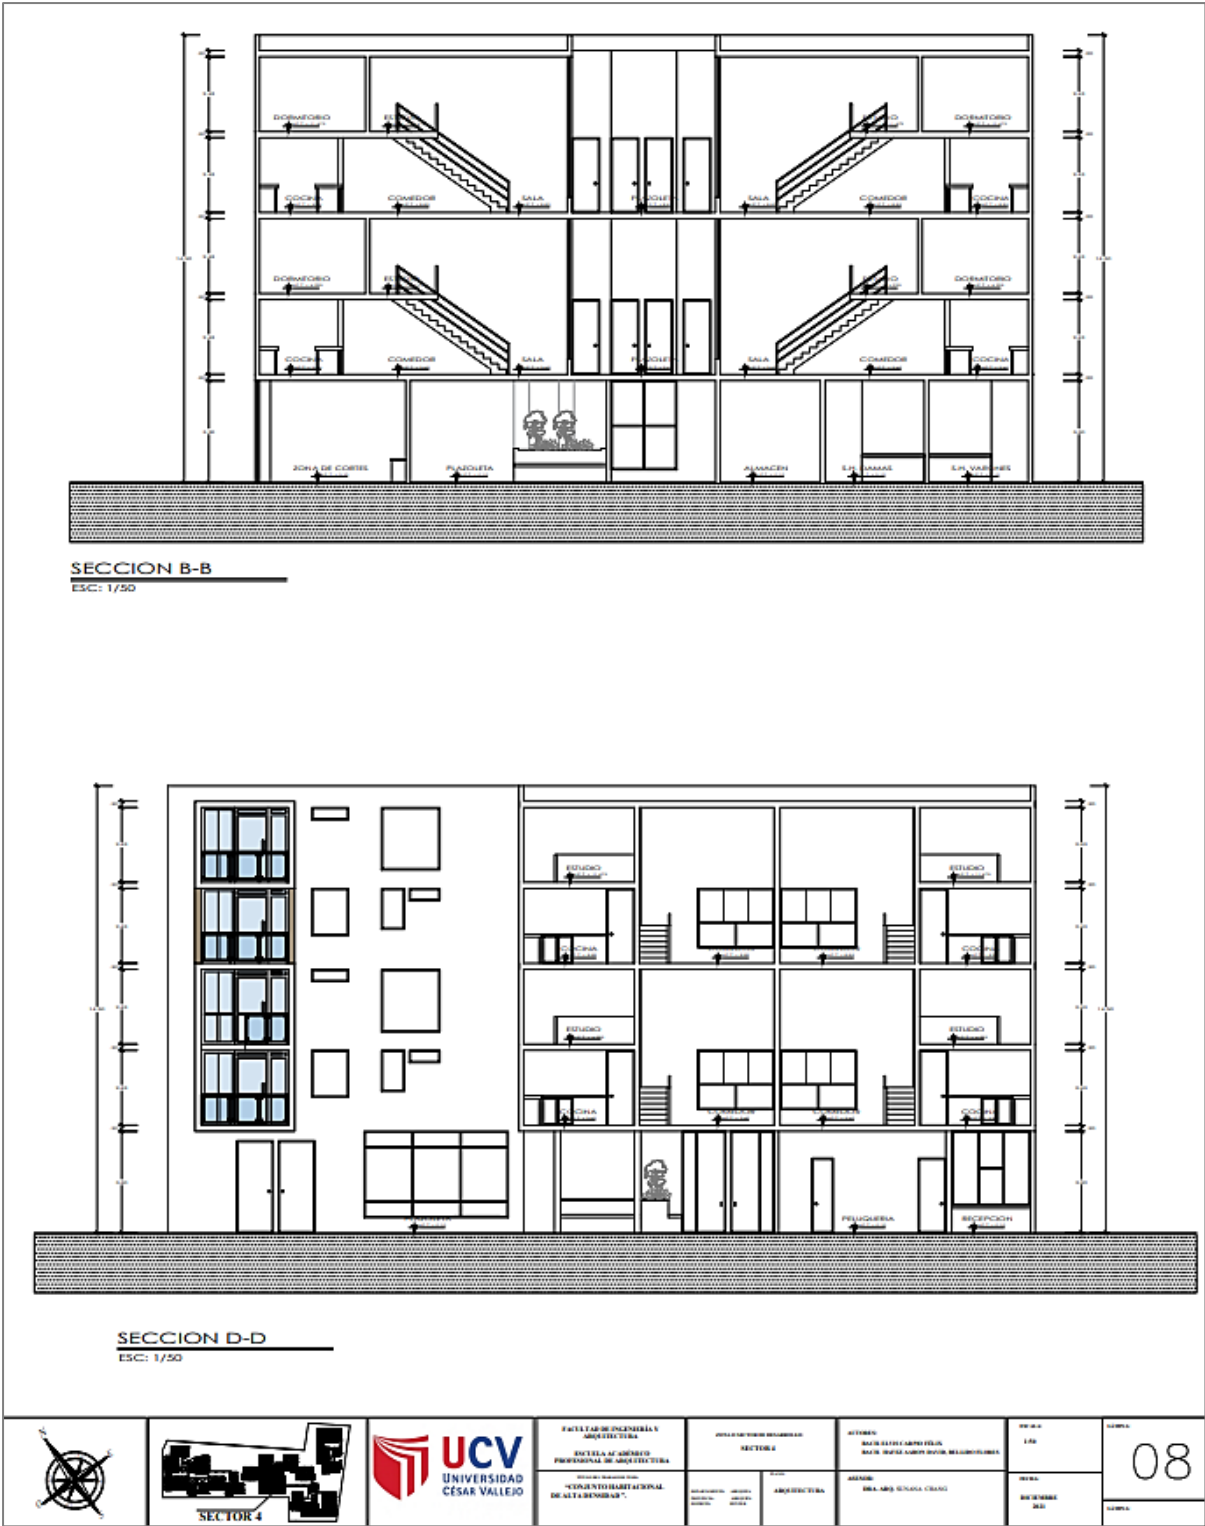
Planos de Arquitectura – 08 - Bloque 4 – Secciones B y D
